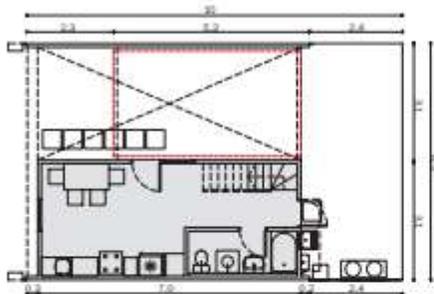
Proyecto Villa Verde de ELEMENTAL. Fuente: www.archdaily.mx
